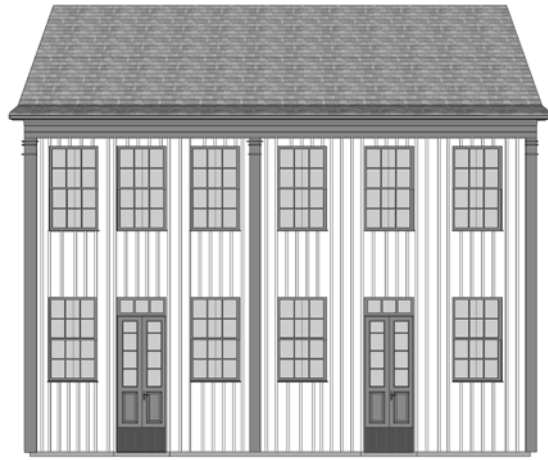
Casa Grezzana, fachada av. dos Imigrantes, orientación norte. FIG. 3.10.12: Casa Grezzana, fachada lateral orientación este. FIG.3.10.13: Casa Grezzana , perspectiva de la fachada principal. FIG.3.10.14: Casa Grezzana, fachada lateral, orientación oeste. Dibujos de la autora.
